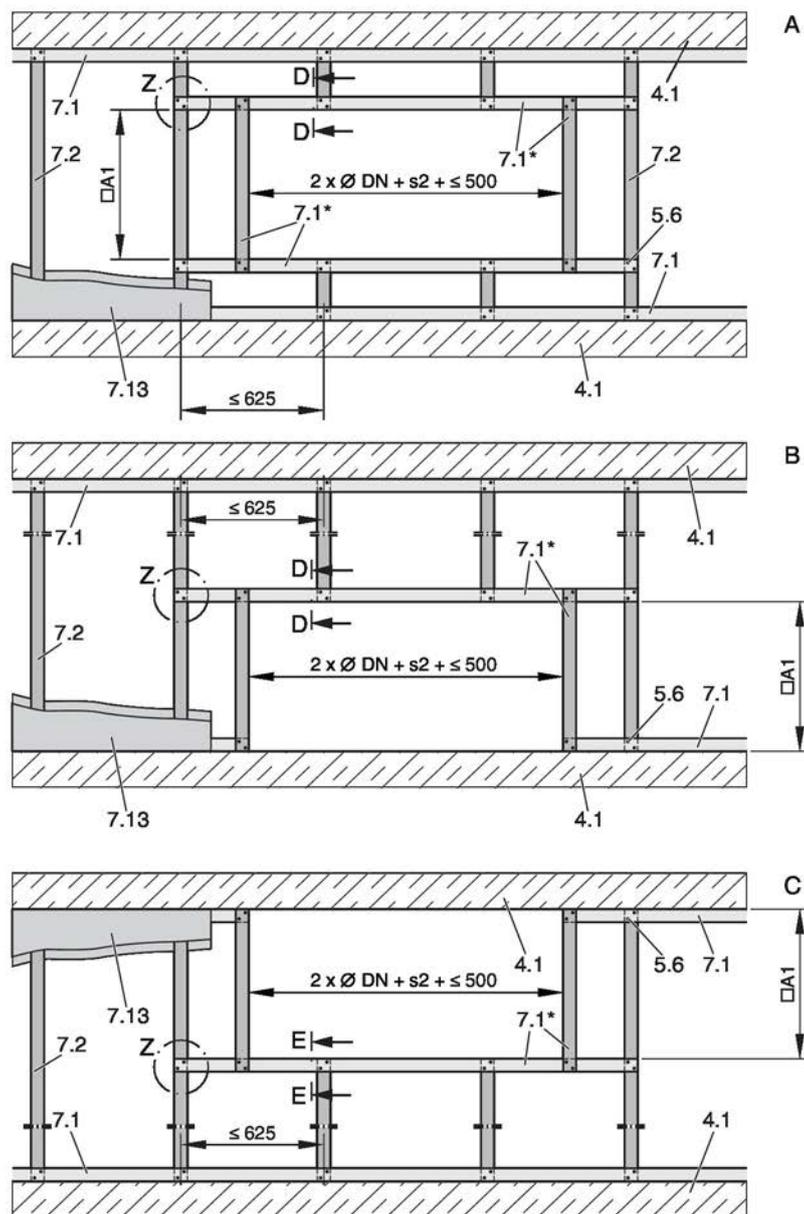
Parede divisória leve com estrutura de apoio de metal e revestimento em ambos os lados, flange a flange, dimensões nominais: Ø largura nominal 315 – 400
